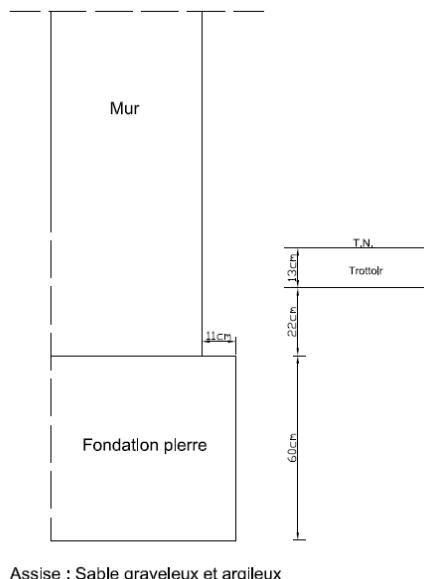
Schéma de la fondation au droit de la fouille RF1
